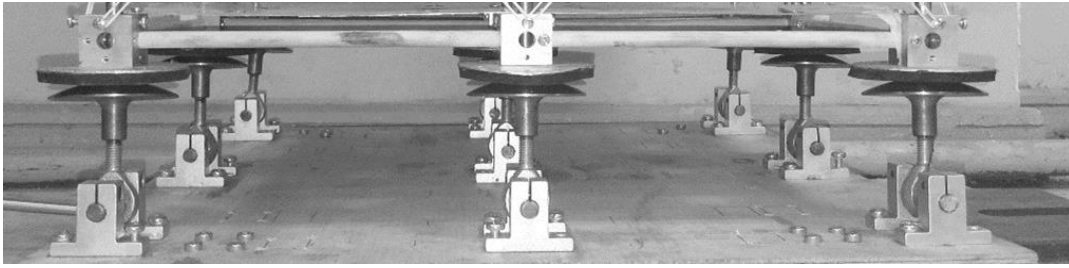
Sistema de aislación propuesto implementado en una maqueta
